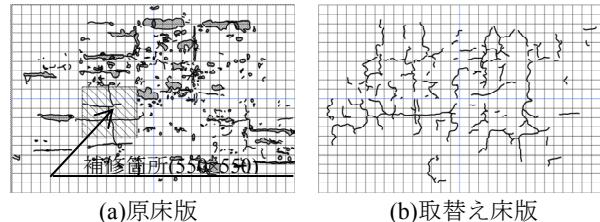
下面ひび割れの発生状況(試験開始前)
